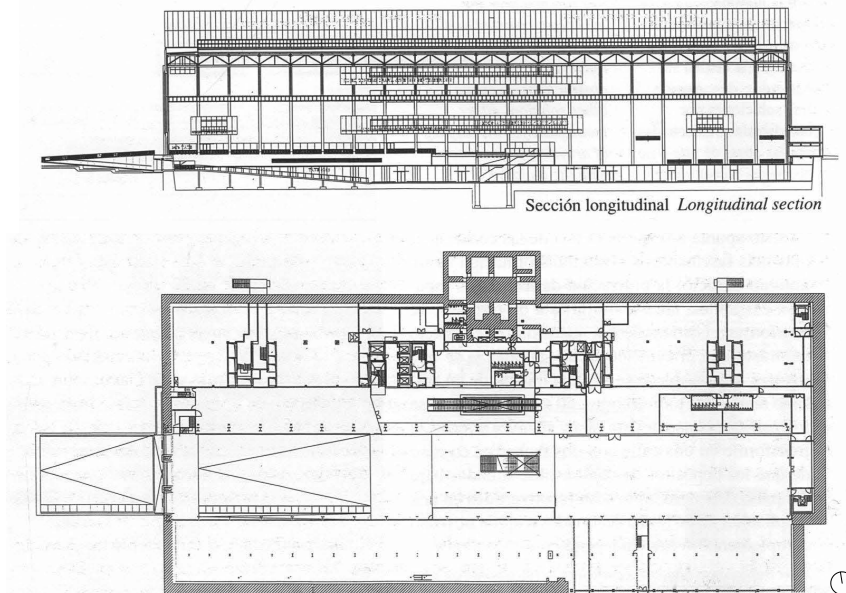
Corte longitudinal e planta do piso térreo da Galeria [Tate Modern], projetado por Jacques Herzog & Pierre de Meuron, de 2000.
